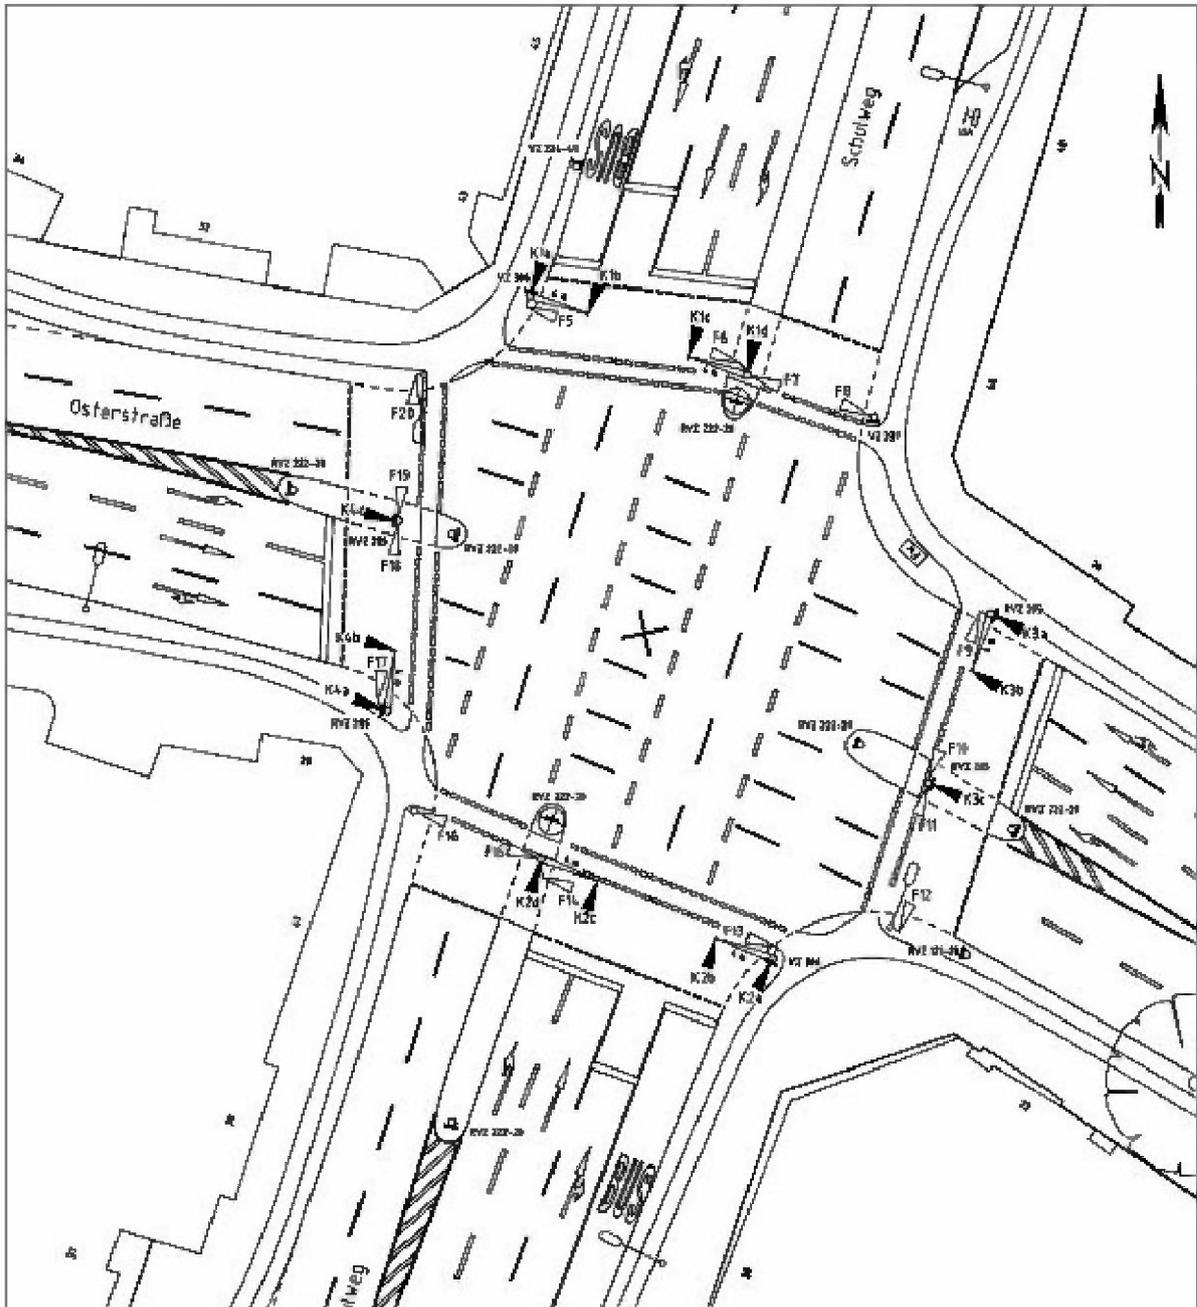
3 Signallageplanausschnitt LSA 87
